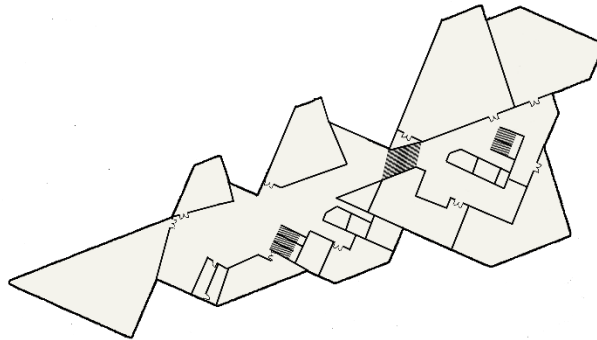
Planta 0 del bloque 5 de la ETSIINF
